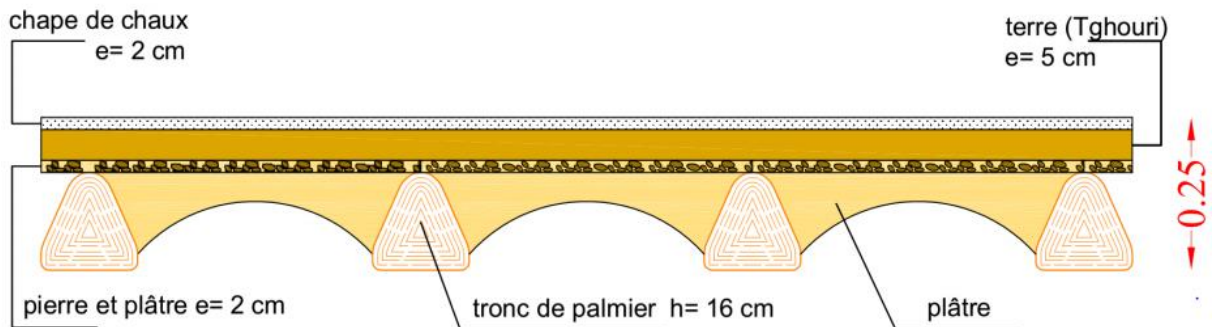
coupe sur plancher. Elaborer par l'étudiante.
